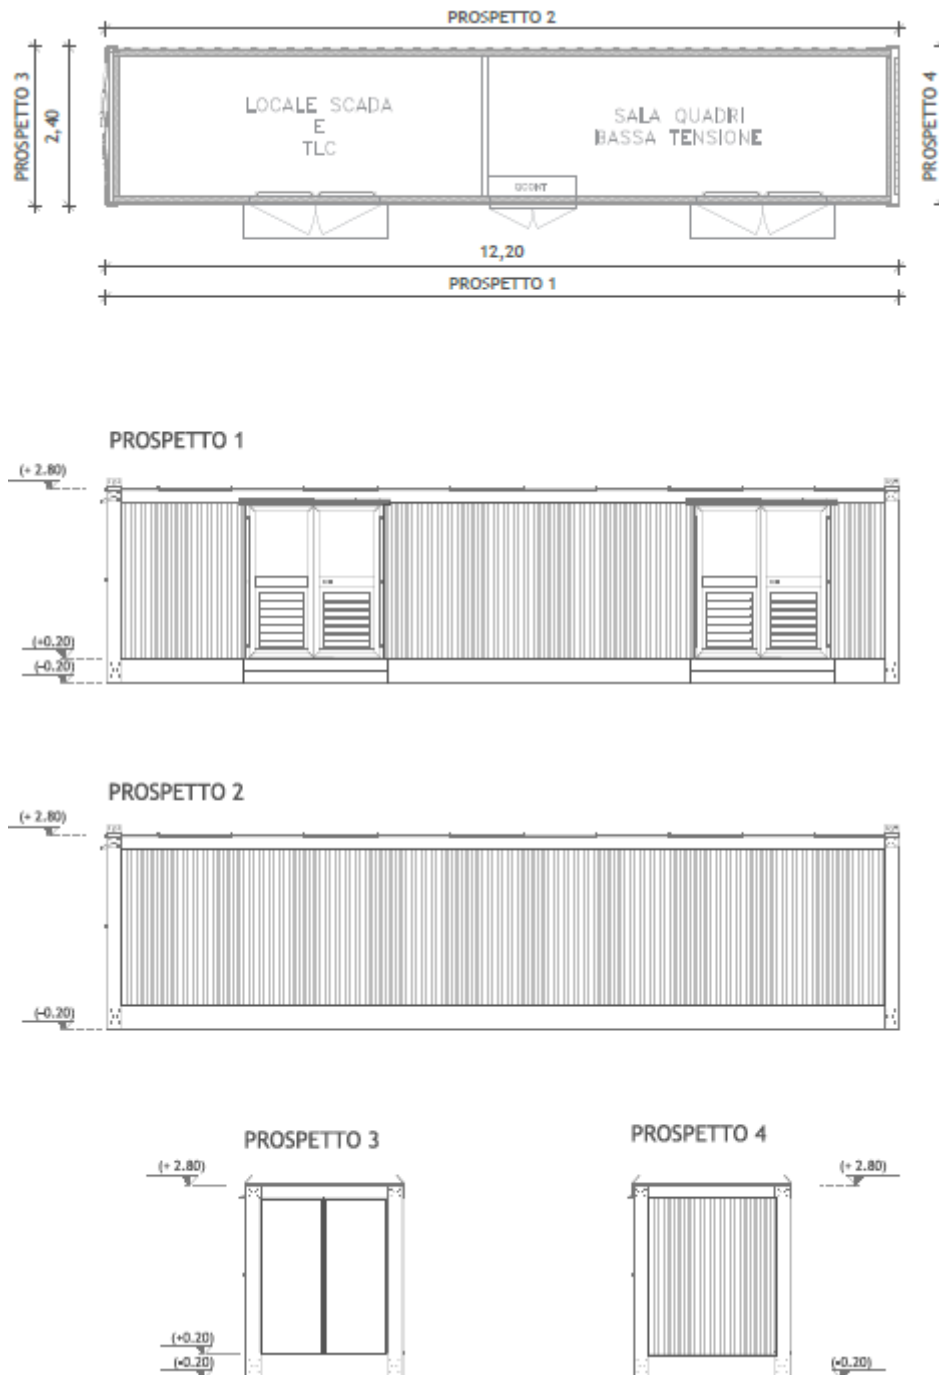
Planimetria e prospetti dell'Edificio BT + SCADA e TLC
